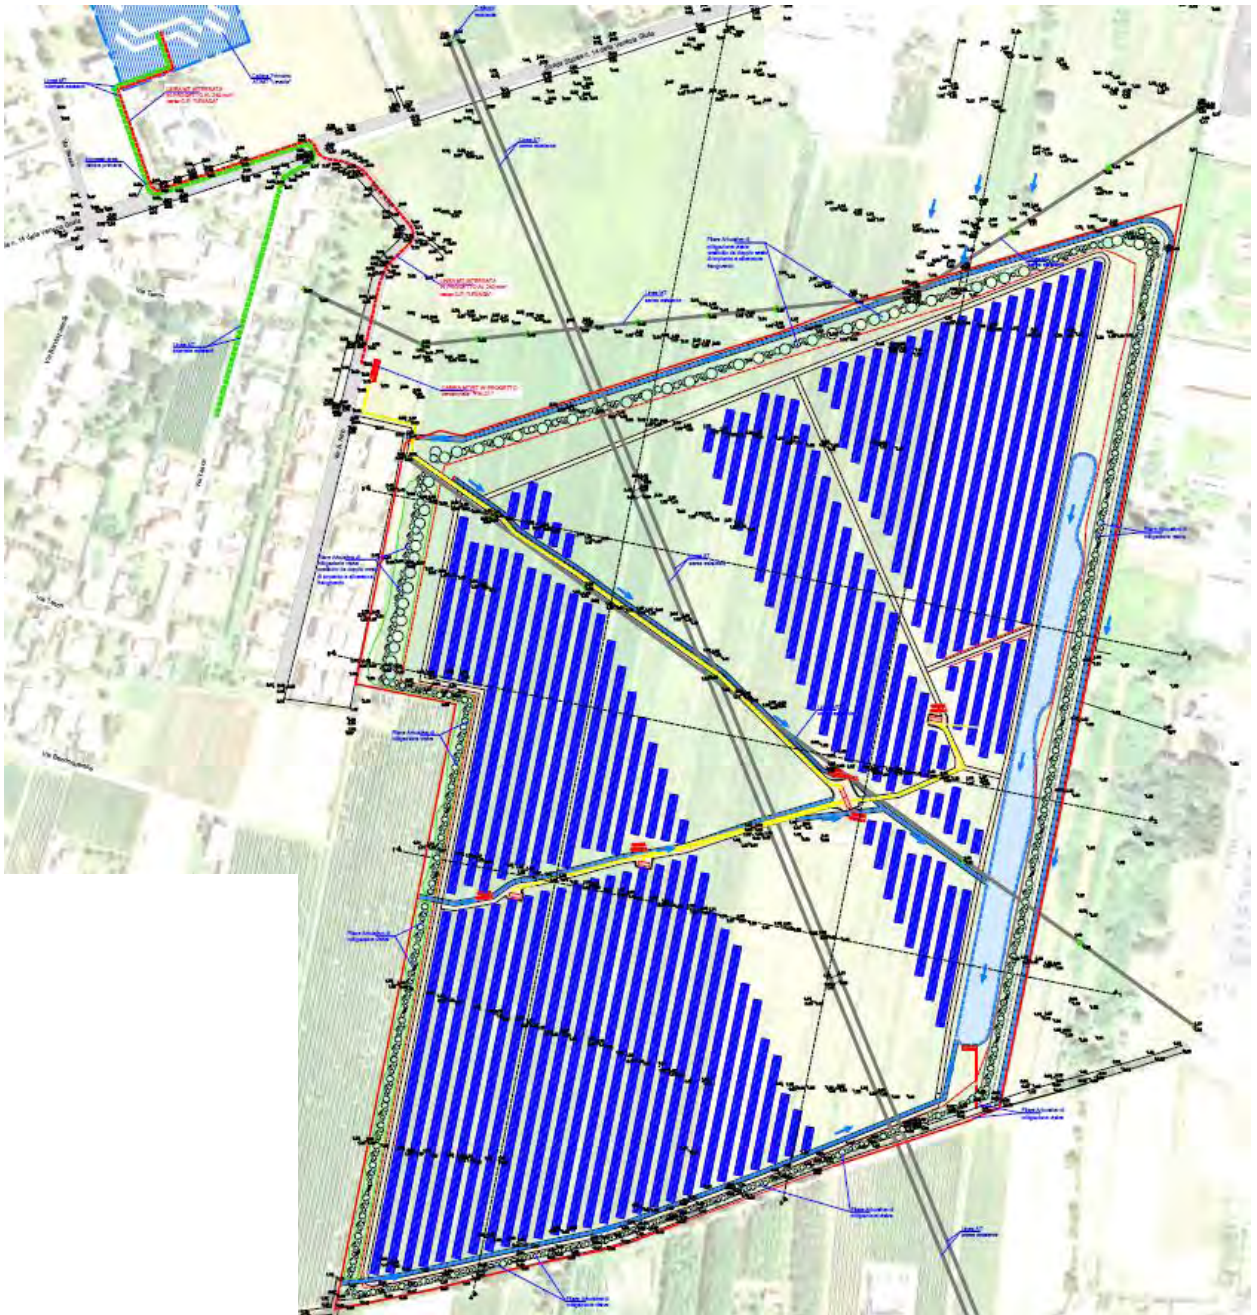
Planimetria di progetto con indicazione dei pannelli e delle principali opere (Estratto tavola T08 Planimetria di progetto)
